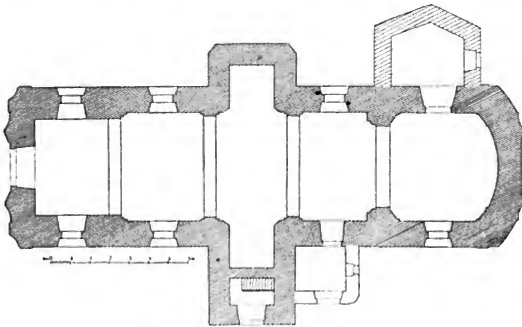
Nebužel. Grundriss der Kirche.
